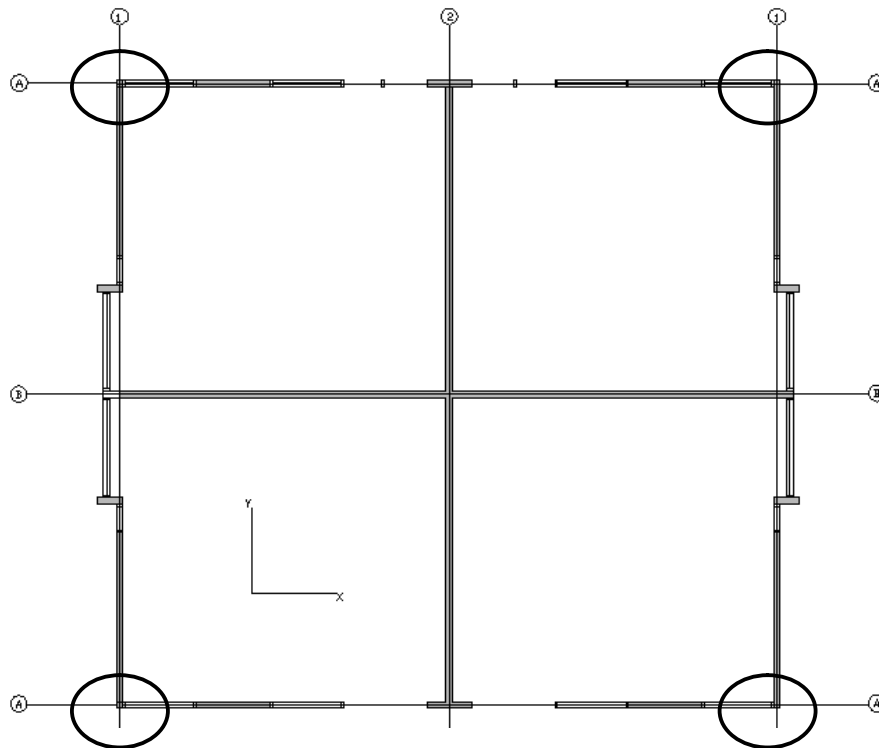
18. Grietas en encuentros de muros de planta tipo edificios Villa Cordillera
